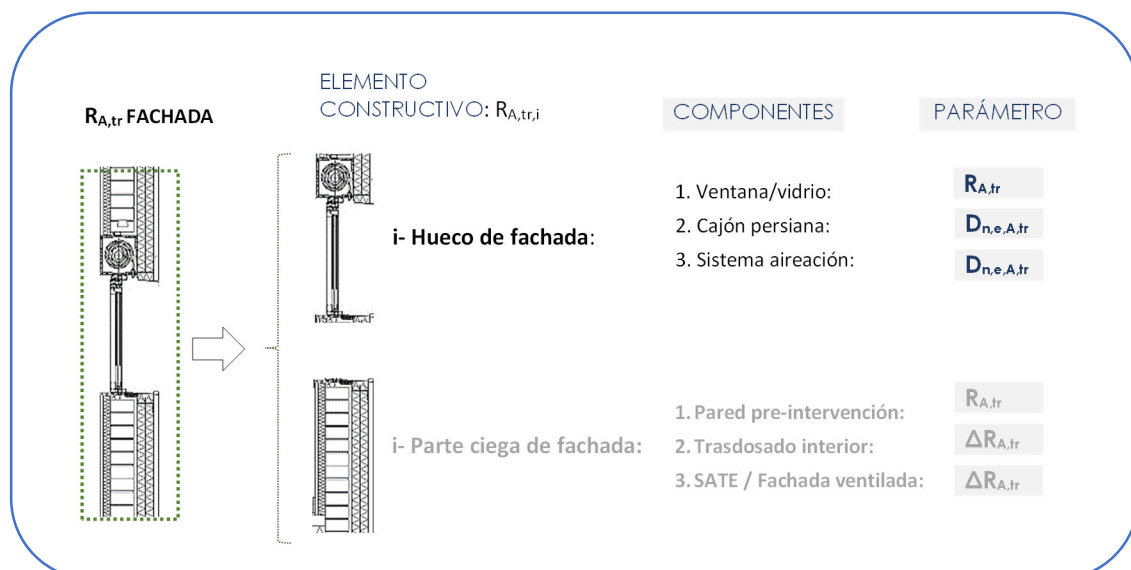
Aislamiento acústico del cerramiento de fachada, $R_{A, tr \text{ FACHADA}}$: Elementos constructivos, componentes y parámetros acústicos que los definen e influyen.
